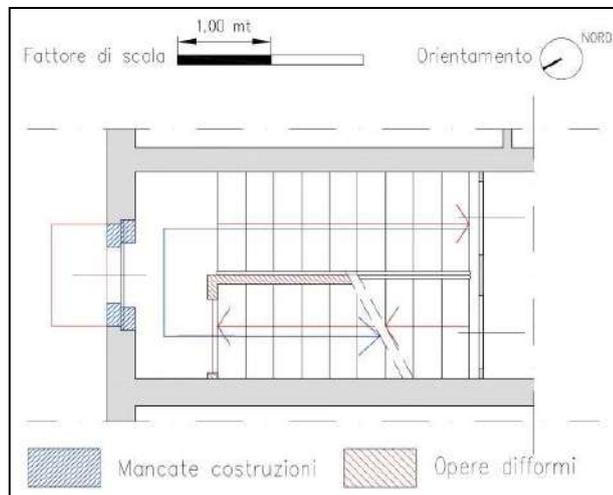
Pianta piano primo - confronto con Licenza di Costruzione n. 1289 del 04.03.1968
